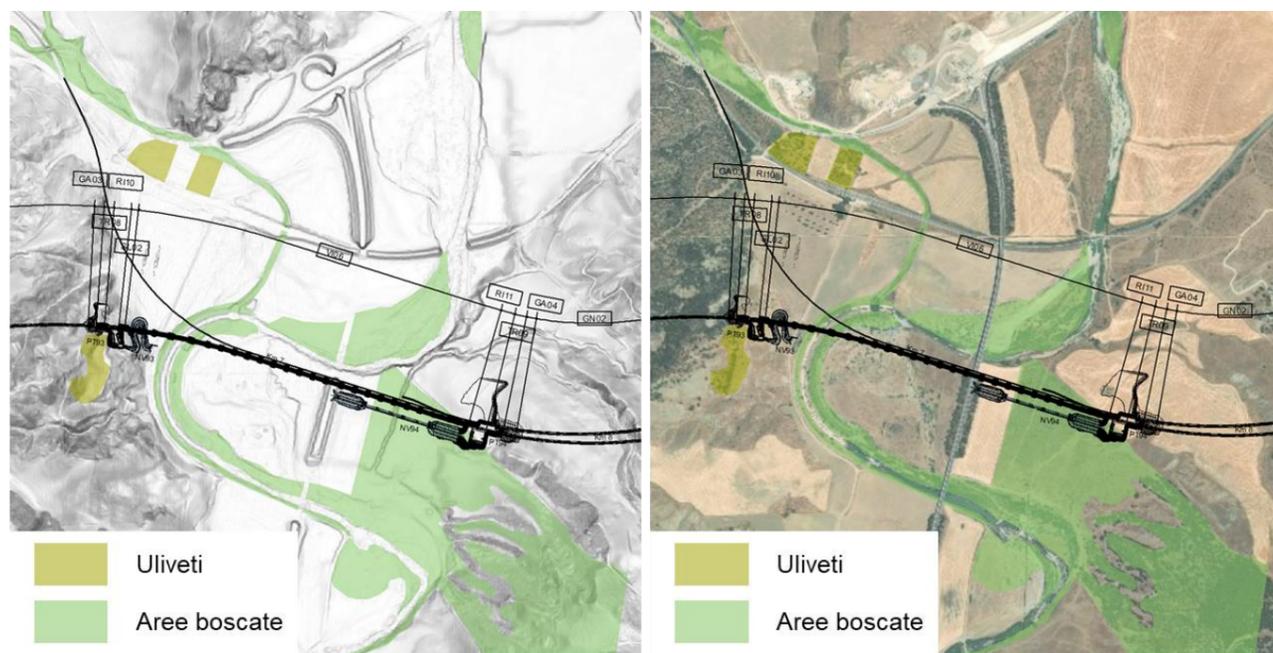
Tratto 2: rapporto con gli elementi strutturanti il paesaggio
